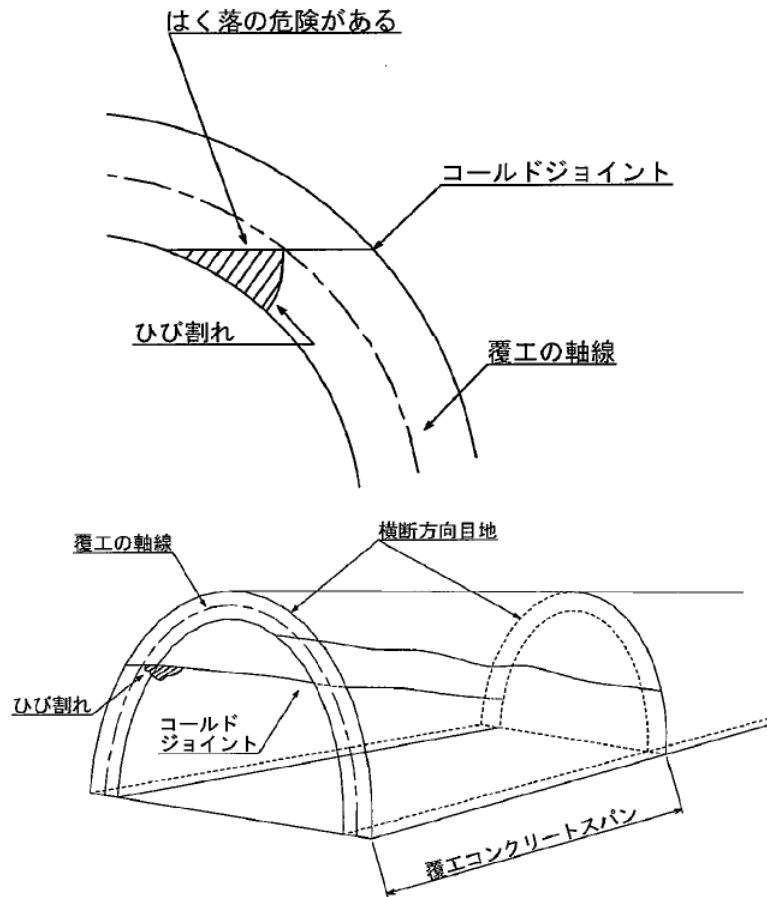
コールドジョイント付近に発生するひび割れの例
